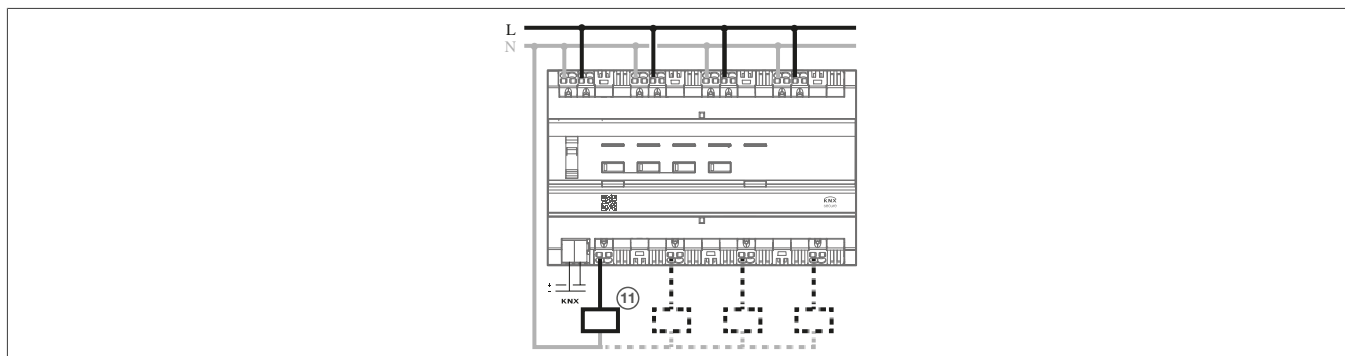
Conexión de dispositivo monofásica - 4 cargas eléctricas
